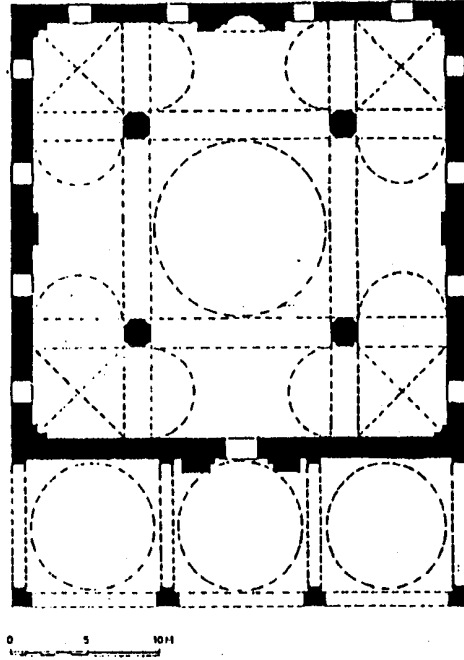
مسقط أفقي لجامع قليج علي باشا في استانبول (عن : Gabriel)
